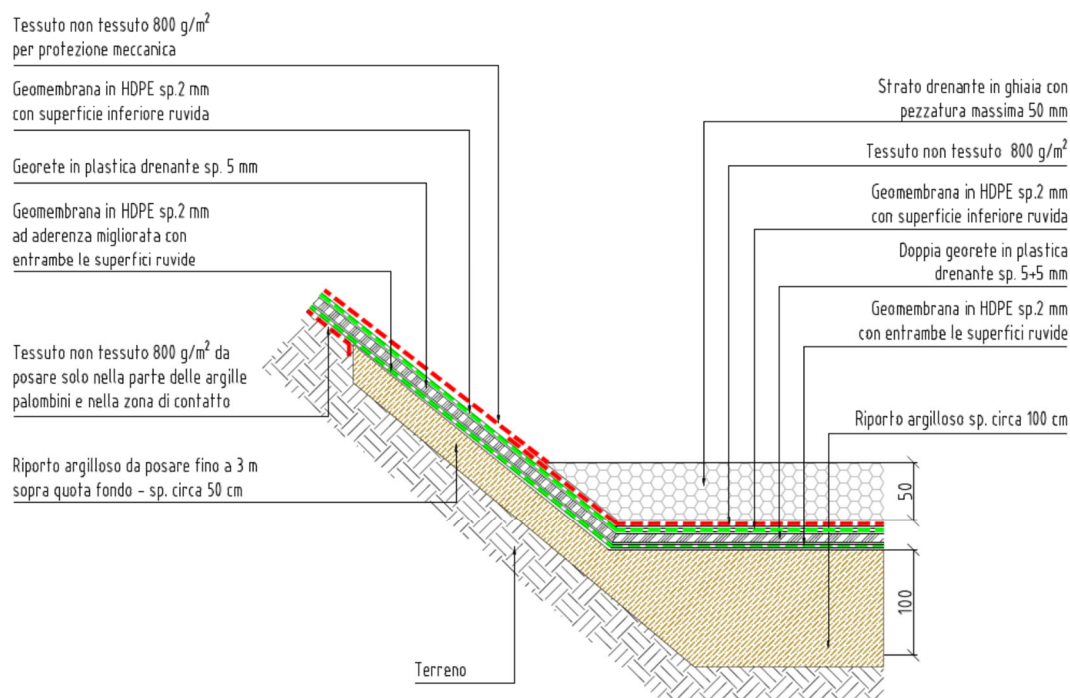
Pacchetto di impermeabilizzazione del fondo e delle scarpate dell'impianto
